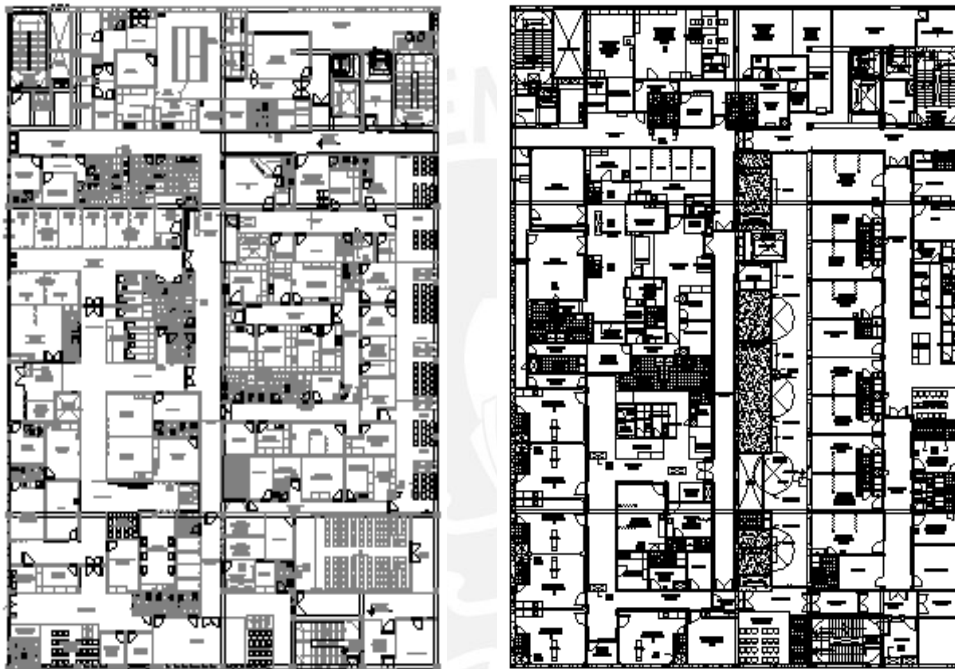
Plantas de arquitectura del primer y segundo nivel.
